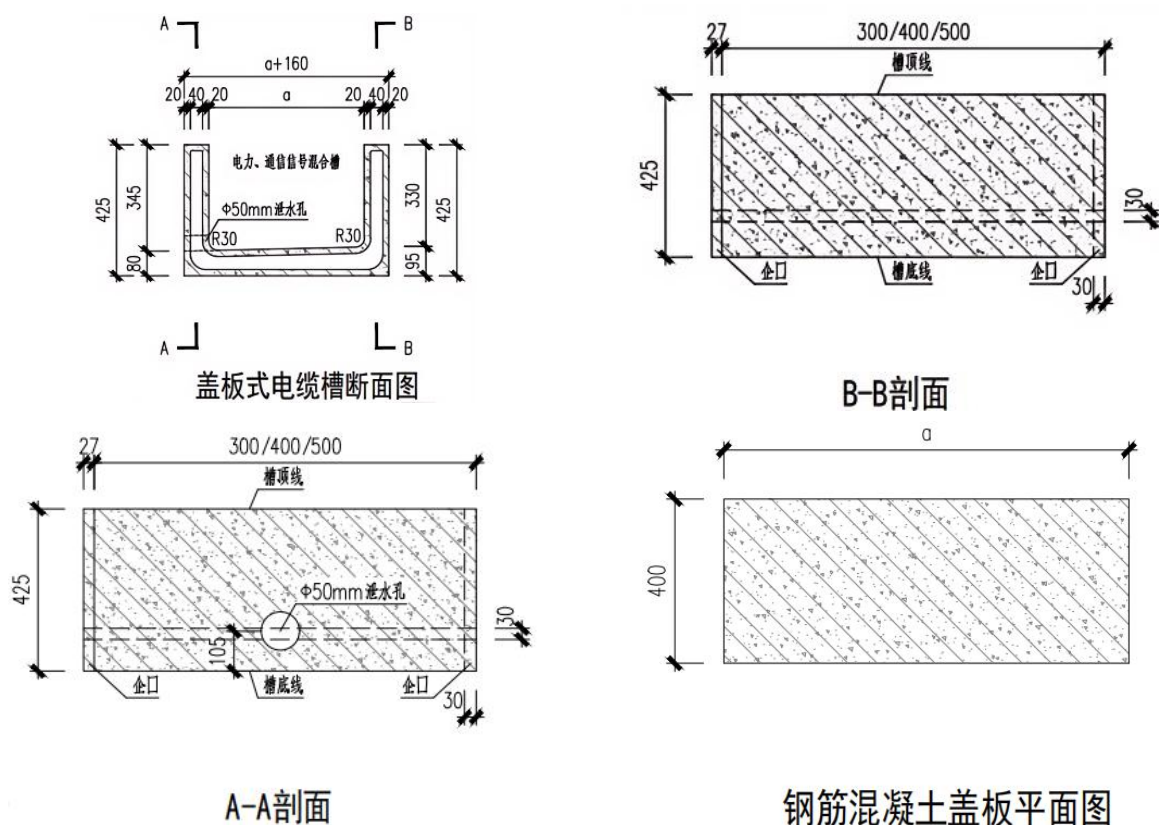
预制混凝土电缆槽（混凝土单槽）
